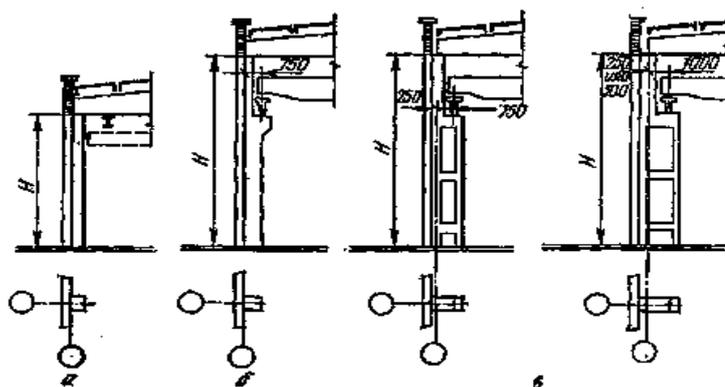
Схема привязки колонн и стен к продольным разбивочным осям
